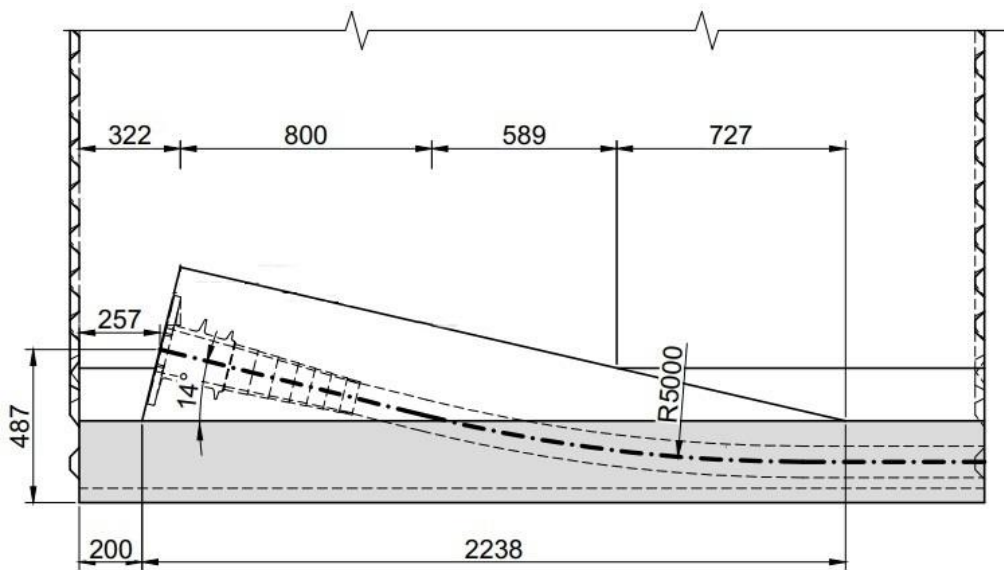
Disposition longitudinale d'un câble de continuité.
